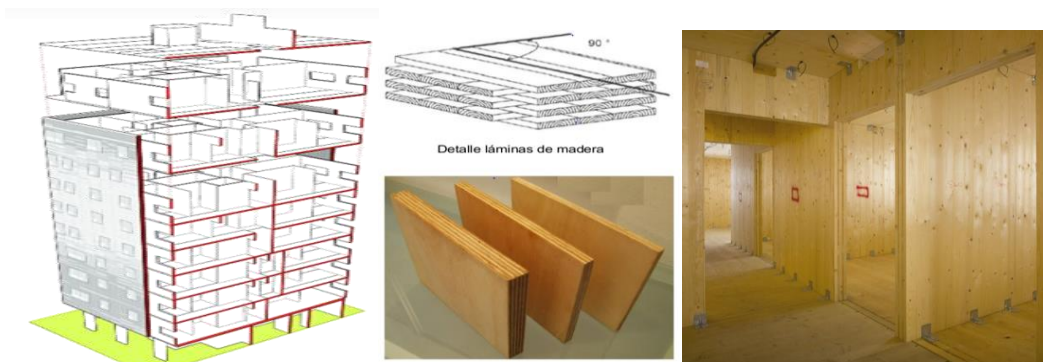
Estructura residencial, edificio de vivienda de alta densidad construido con paneles prefabricados de madera laminada. Tomado de: ArchDaily Colombia, 2009. Referencia: “Stadthaus, 24 Murray Grove por Waugh Thistleton Architects” por ArchDaily Colombia, 2009. Recuperado de <https://bit.ly/2MCD4FJ>
